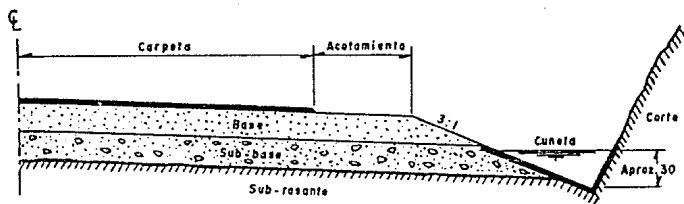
Disposición más conveniente de la cuneta, respecto al pavimento. Sección en corte, sin subdrenaje
